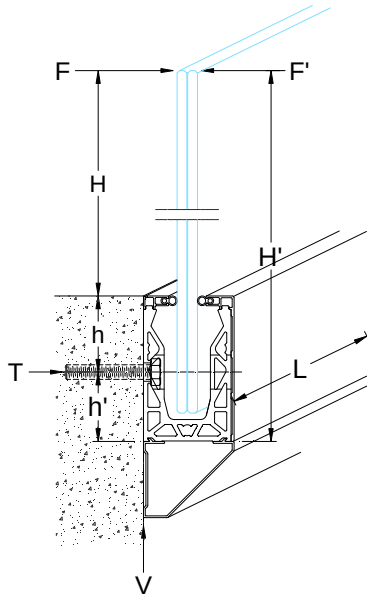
Fender Glass/DEFENDER-DF450 – Montage sur dalle
